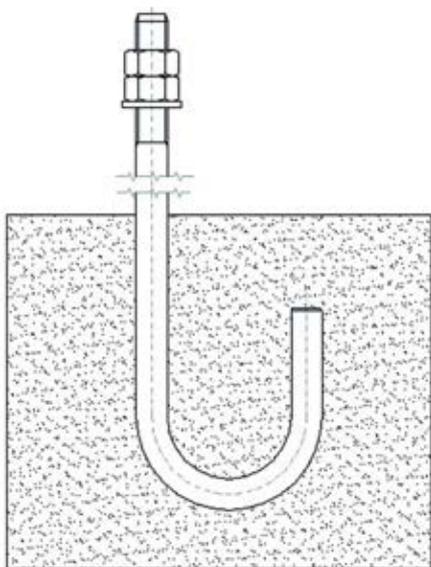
Fondations pour la fixation du groupe pompe moteur.
